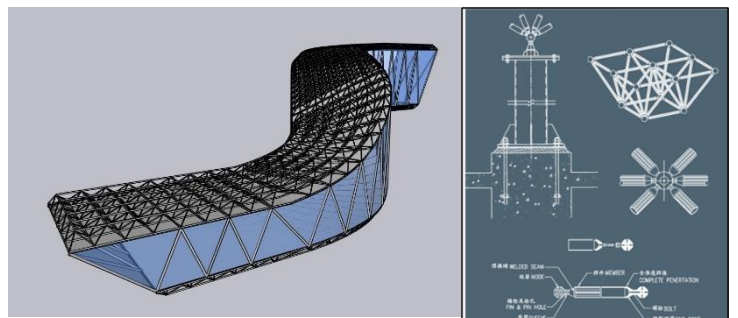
structure tubulaire en double nappe tridimensionnelle.
